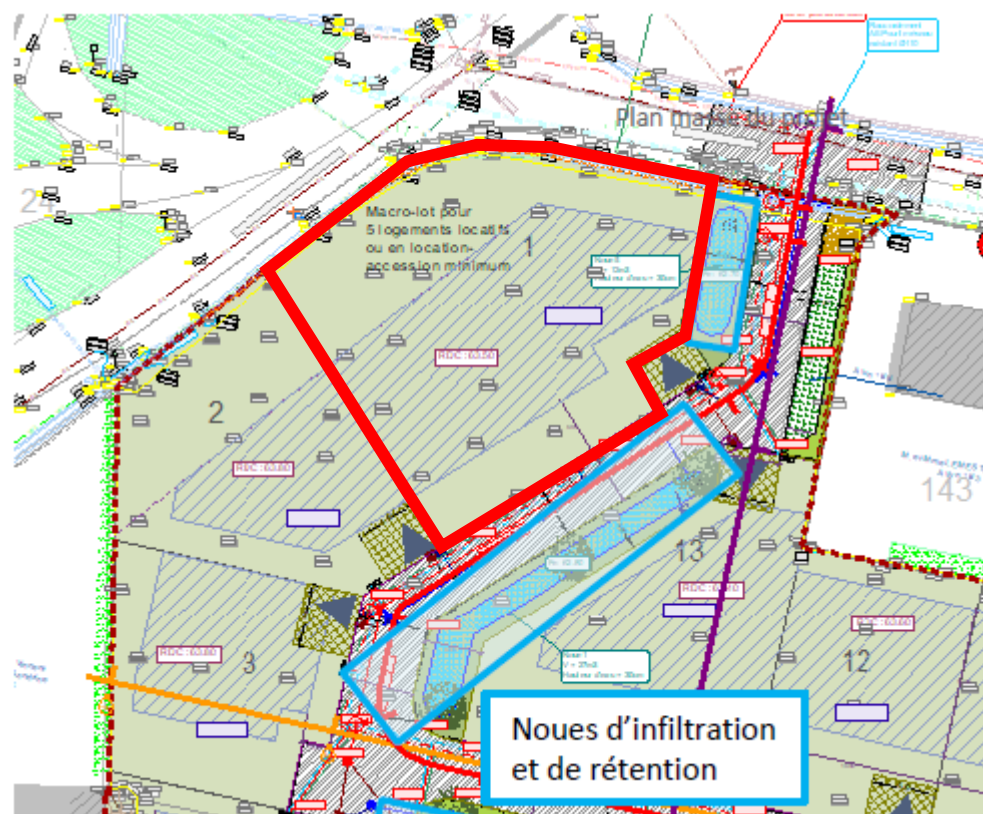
Extrait du plan de lotissement (Servicad Ingénieurs Conseils – Note hydraulique -03/2023)
